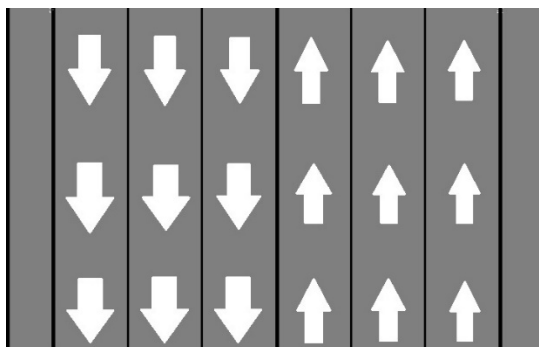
Vista típica de una vía de 6 carriles. Fuente: elaboración propia
